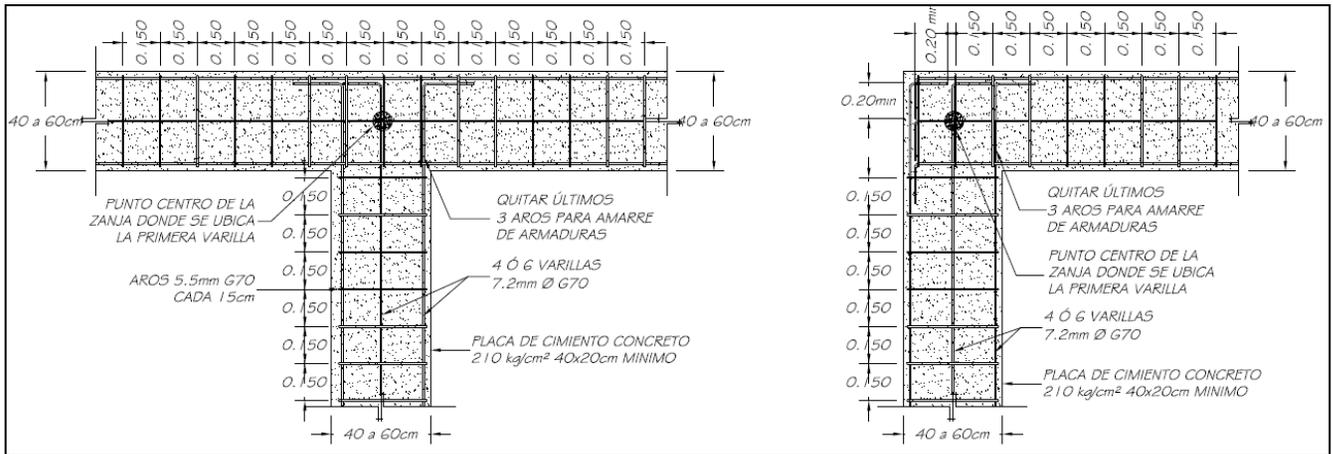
Detalle de traslape de Armaduras y colocación del acero de refuerzo.
